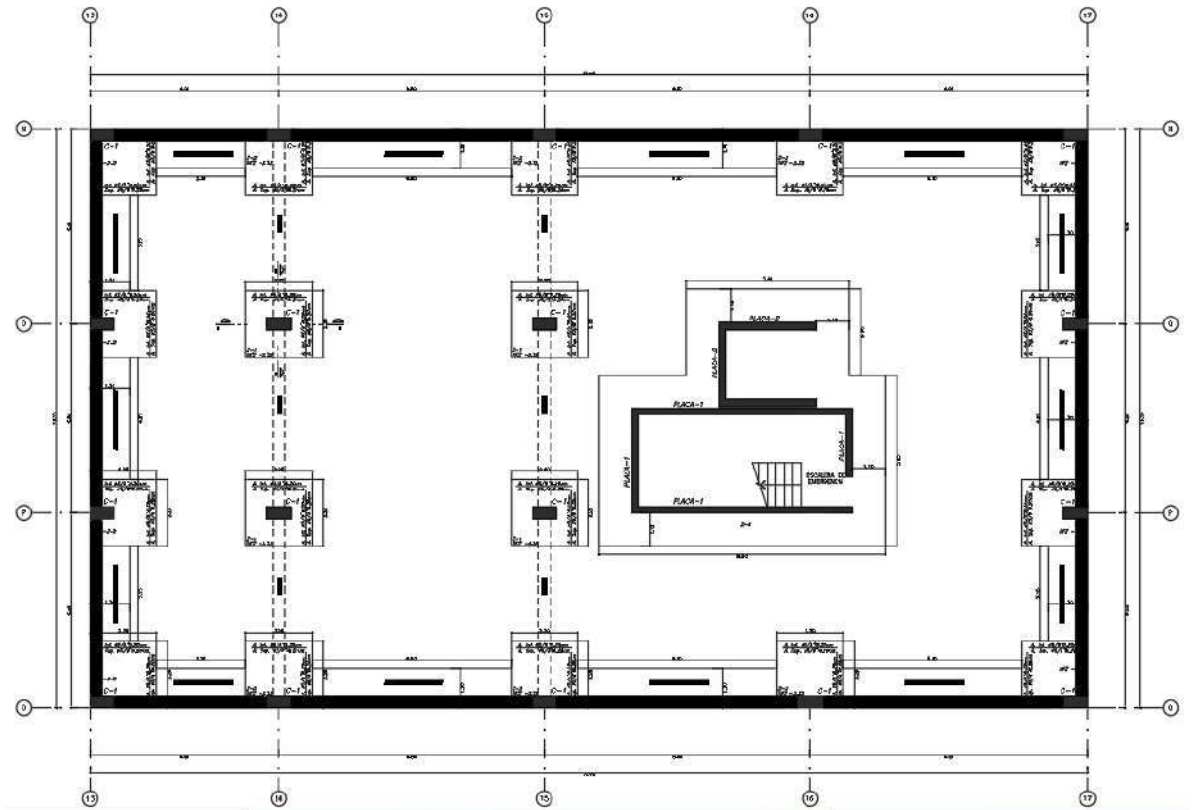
Tipo de cimentación del sector donde se muestra la distribución y colocación de las zapatas conectadas de dimensiones 2.20m x 2.20m
